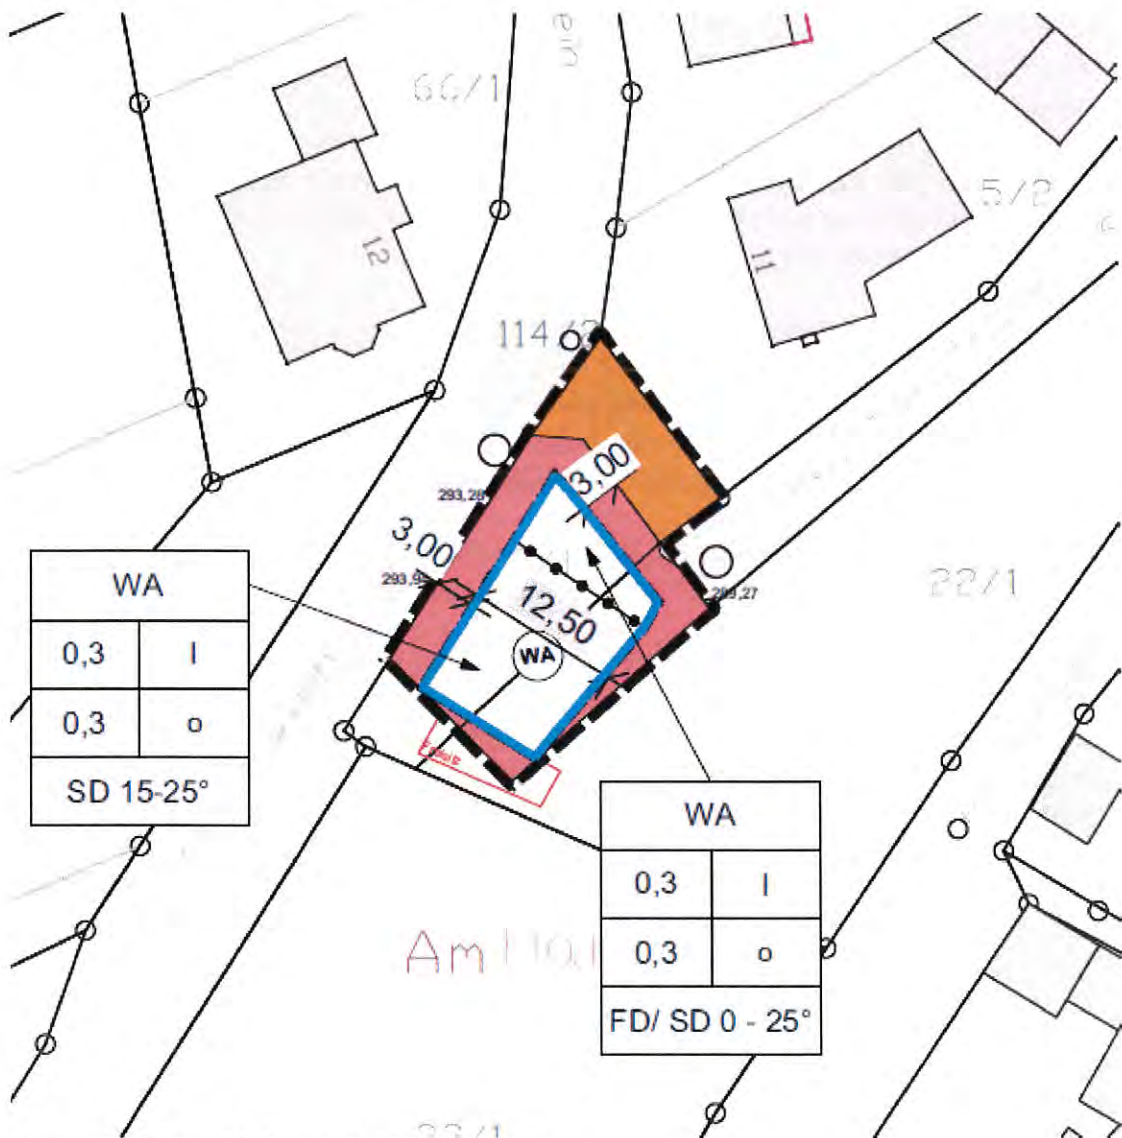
Entwurf Bebauungsplan 02/2022, o.M.
